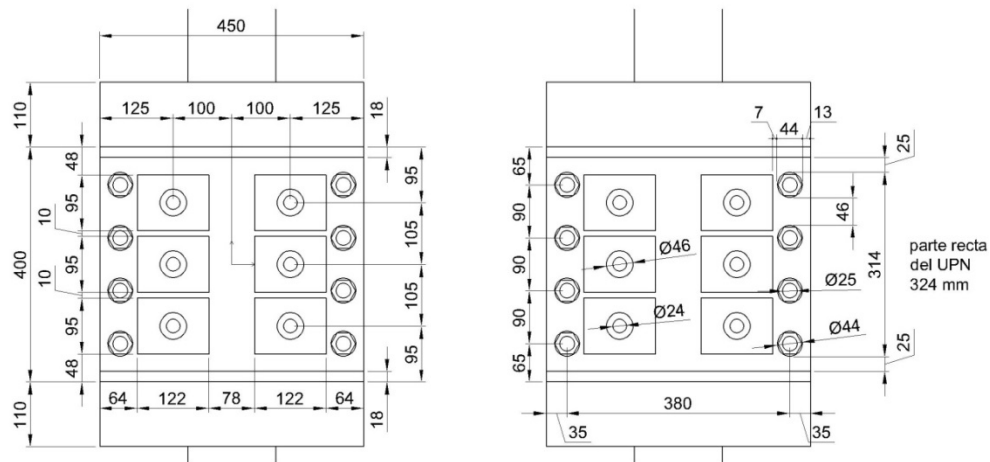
Detalle de la posición de las barras roscadas y placas de anclaje para el pretensado (mm)
